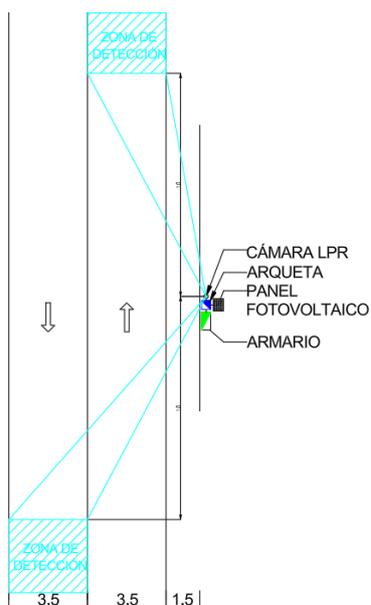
Instalación planta LPR dos carriles. Fuente: Elaboración propia.
